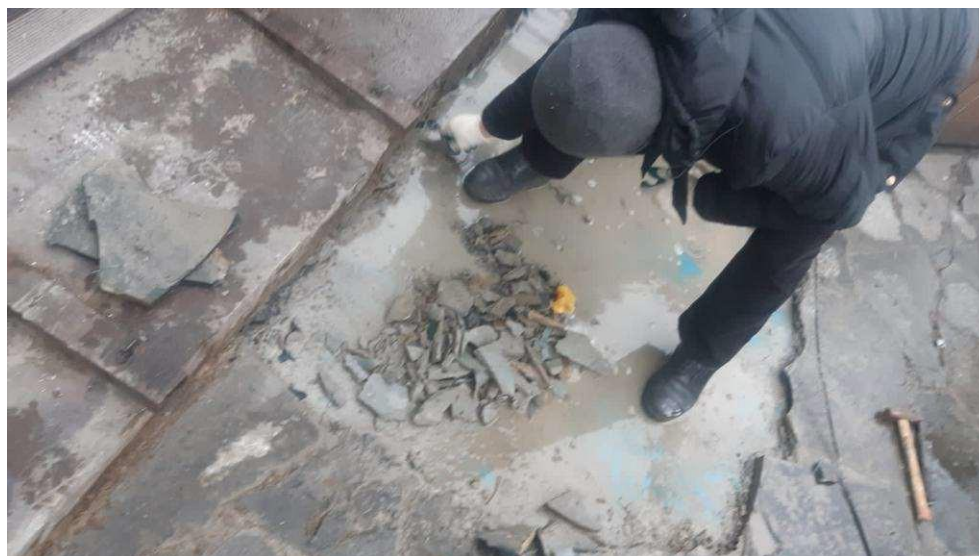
Дефектная гидроизоляция террасы кв. 49 , при вскрытии обнаружена вода.
